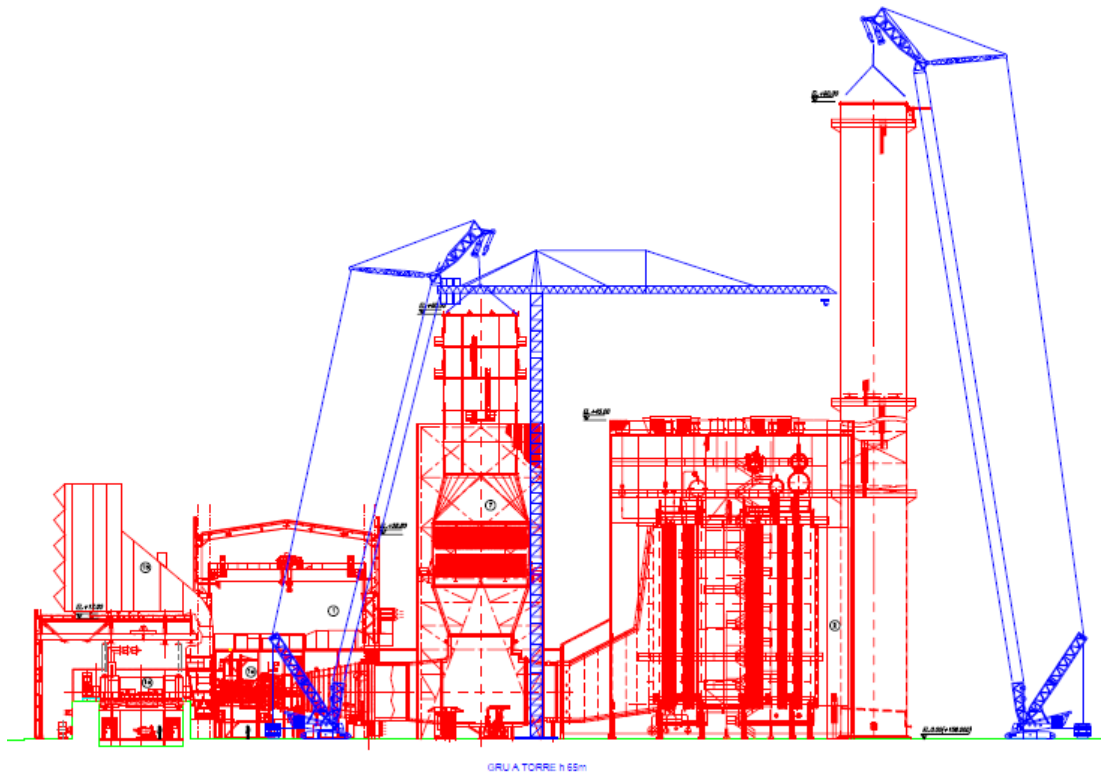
Sezione tipo mezzi di sollevamento
